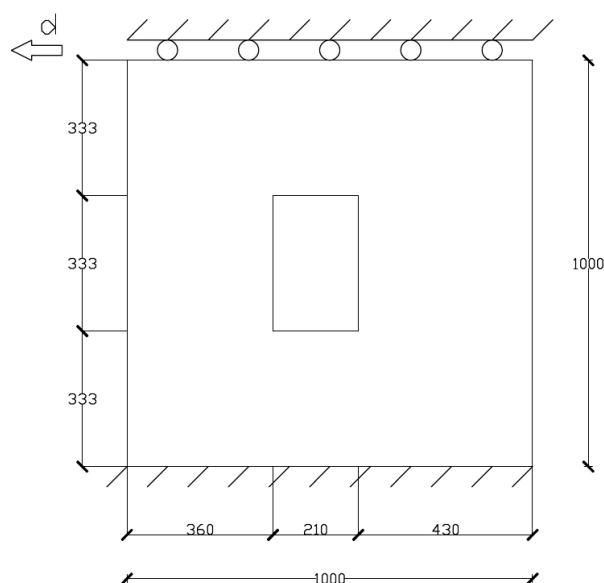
Parede de alvenaria em análise (dimensões em mm).
